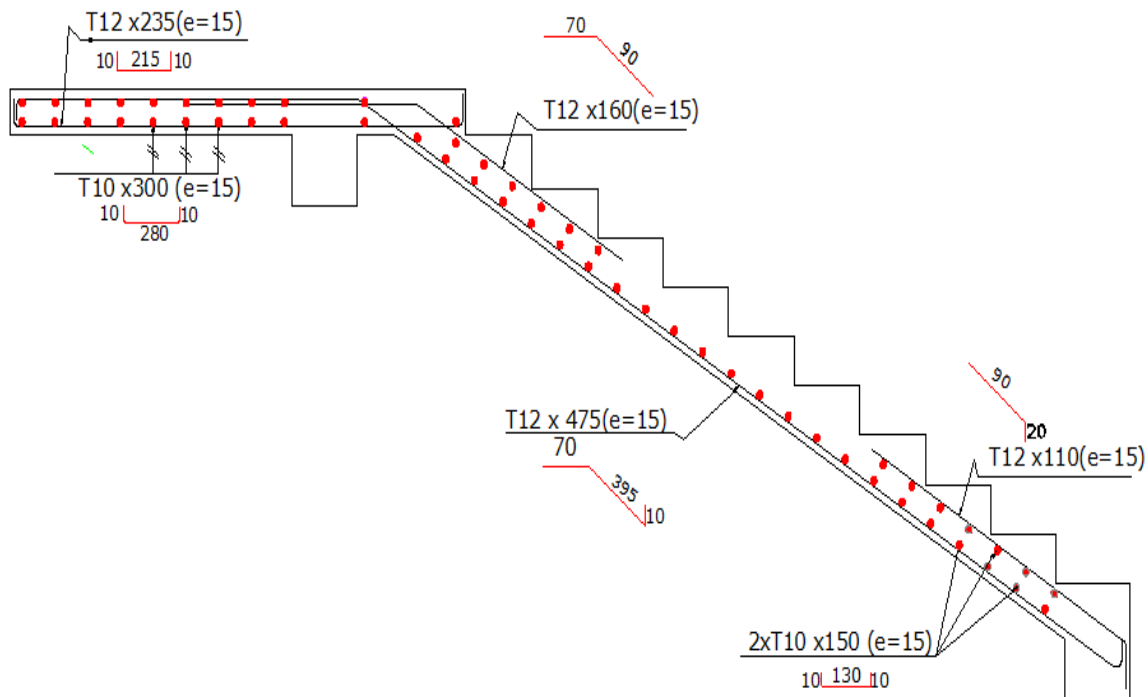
Schéma de ferrailage de la 1^{ère} volée de l'escalier de sous-sol
